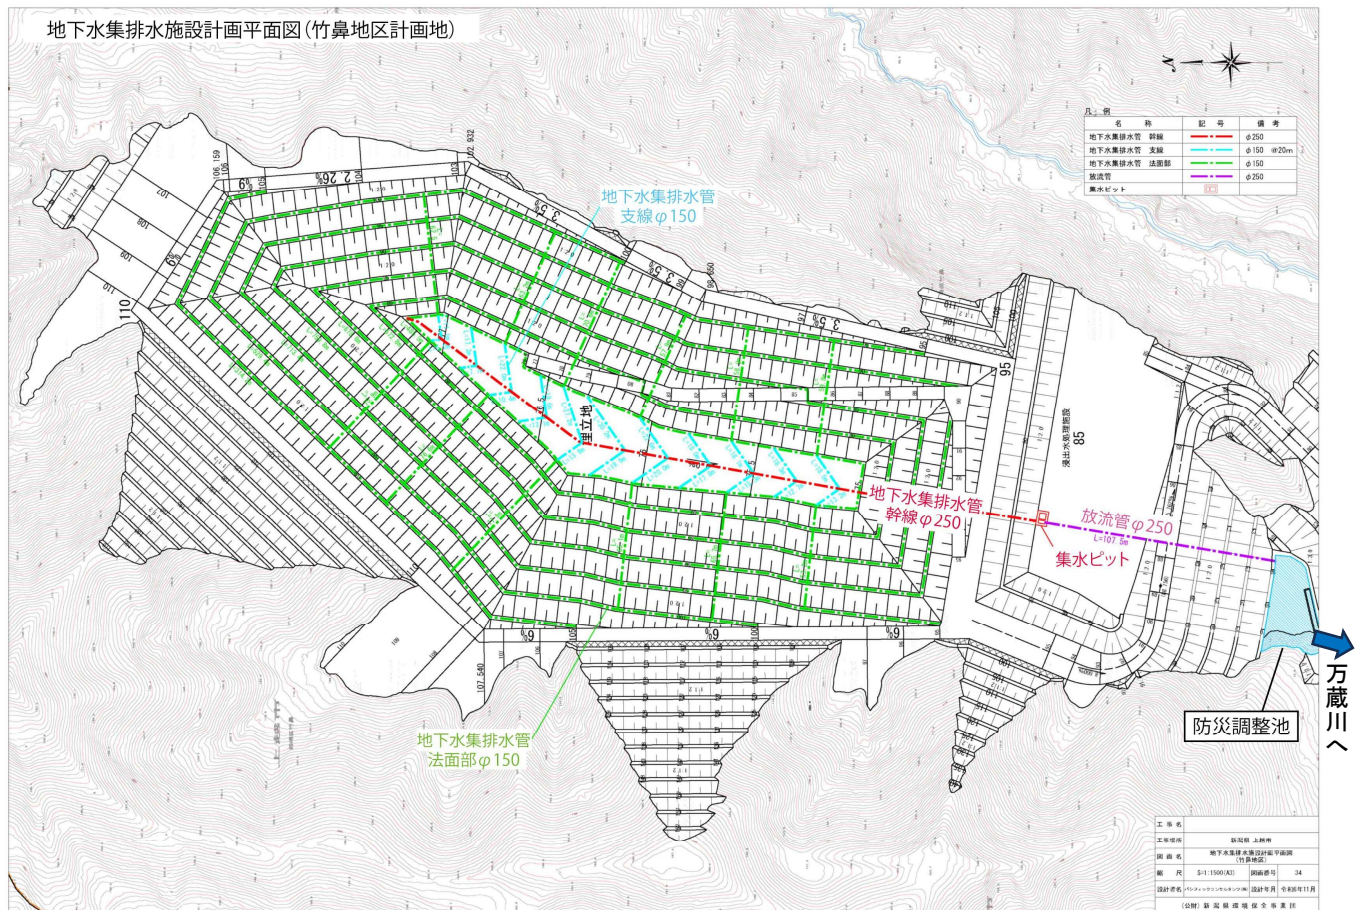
(1) 地下水集排水施設計画平面図 (竹鼻地区埋立地)
